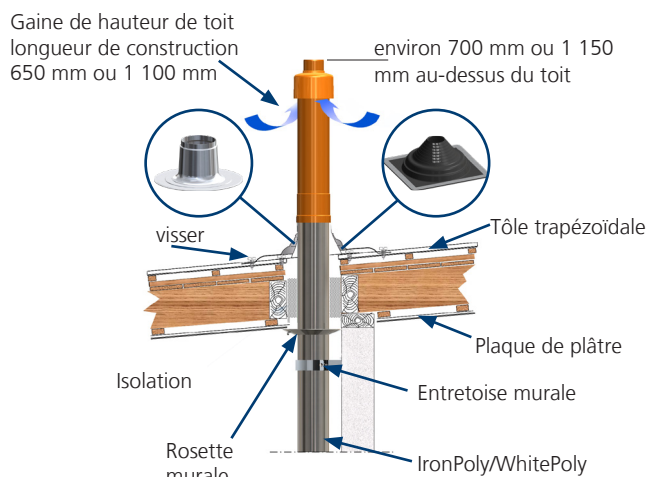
Exemple de conduit de toit plat pour couverture en tôle trapézoïdale
